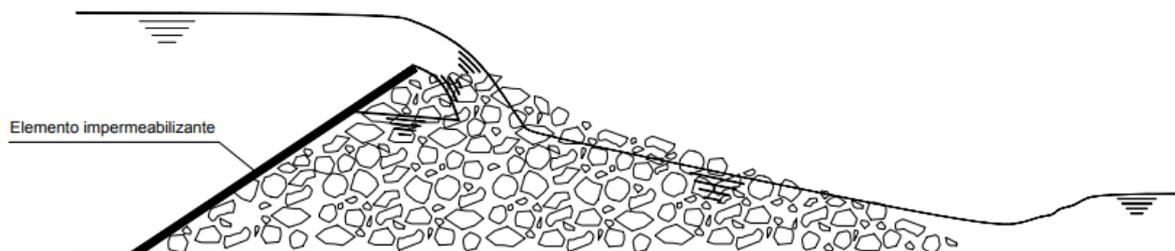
Impermeabilização a montante através da laje de concreto armado
